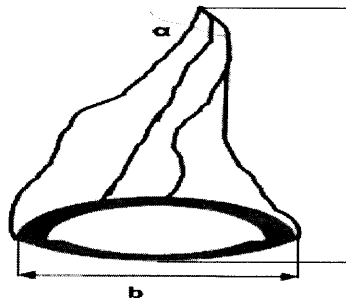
Processus d'affaissement du coin de voûte surmontant une excavation.
